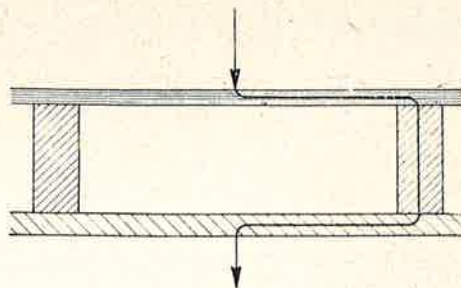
De overdracht van trillingen in een houten balkvloer.
